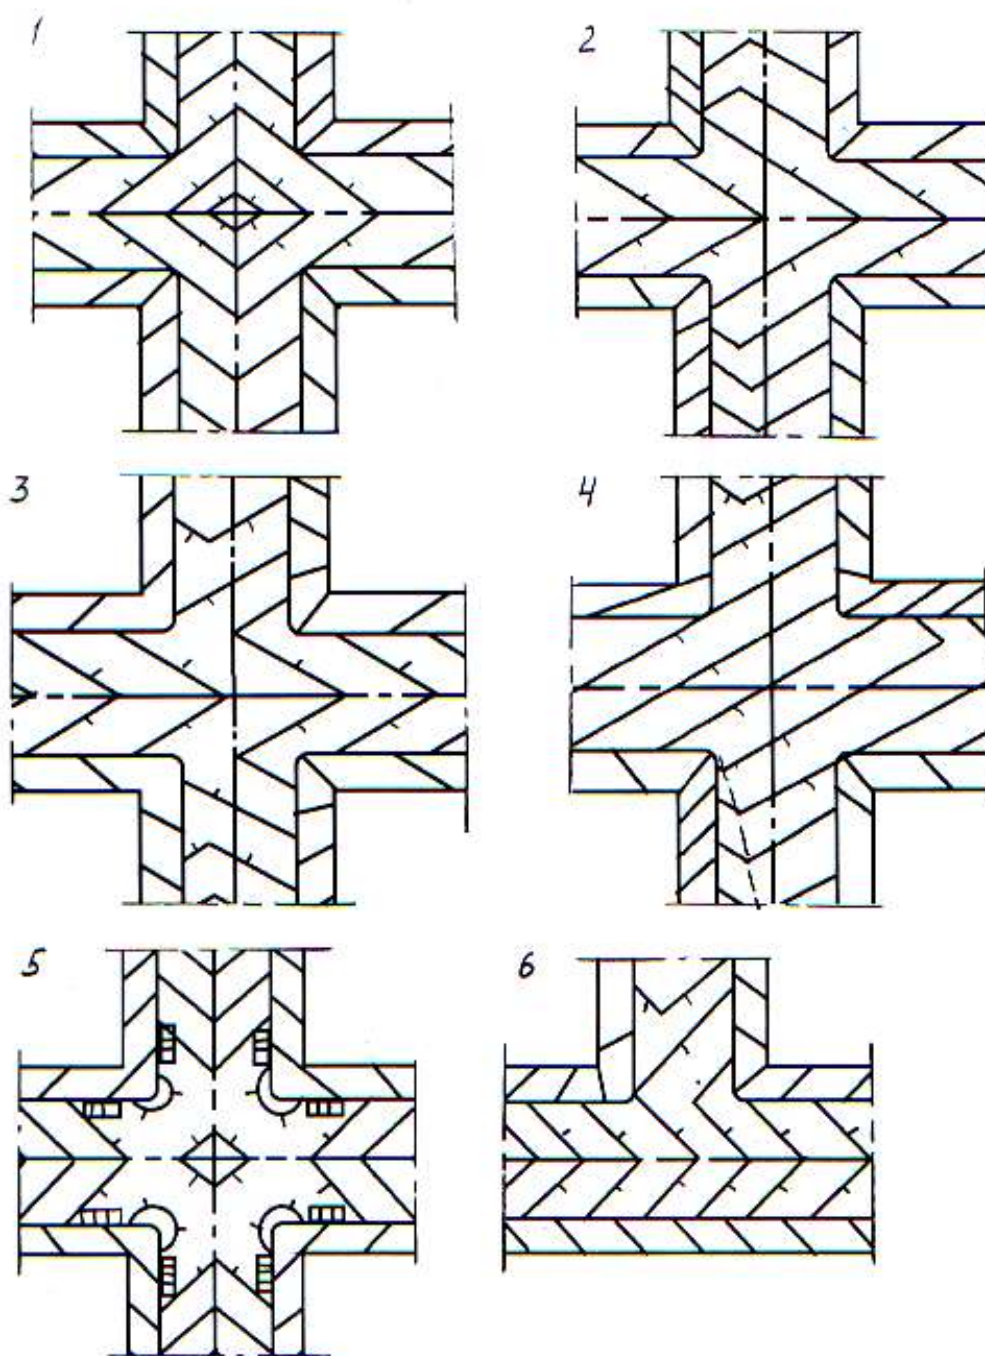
Схемы вертикальной планировки перекрестков в зависимости от рельефа: 1 – на холме; 2 – на водоразделе; 3 – в тальвеге; 4 – на косогоре; 5 – в котловине; 6 – Т-образные перекрестки
